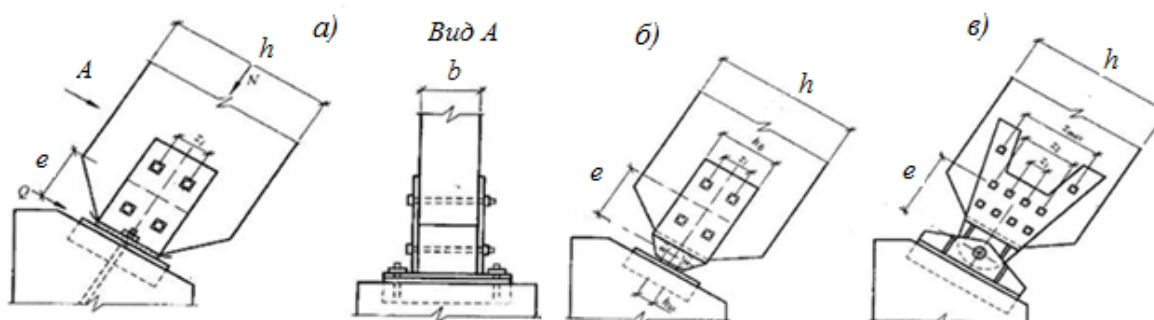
Конструктивное решение опорного узла арок с простым лобовым упором и с парными накладками (а) и в виде классического шарнира (б, в)
